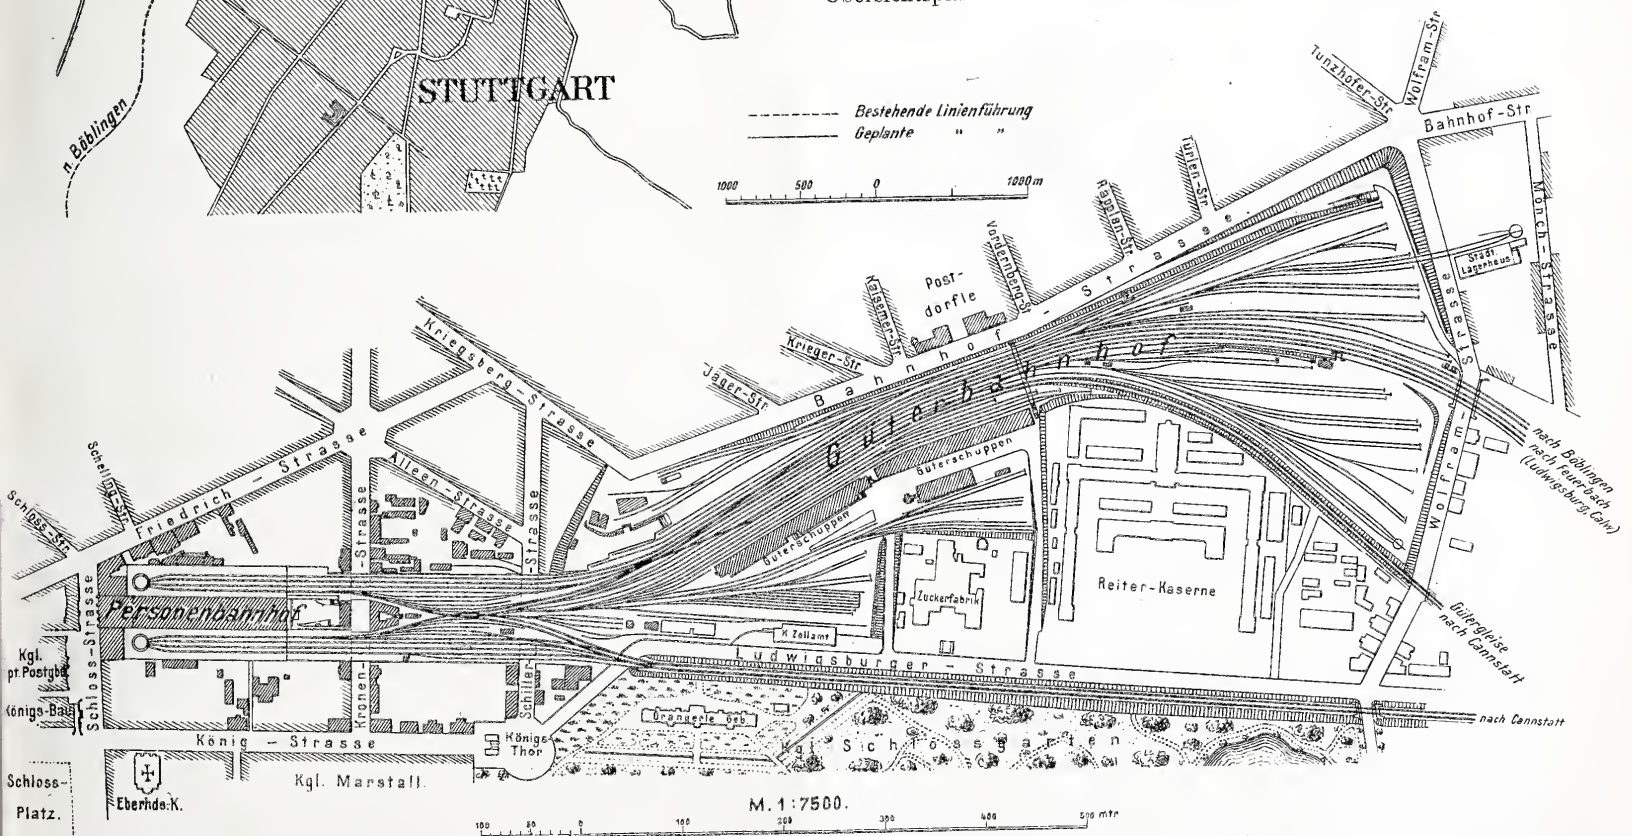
Hauptbahnhof Stuttgart. Stand vom Jahre 1904.
